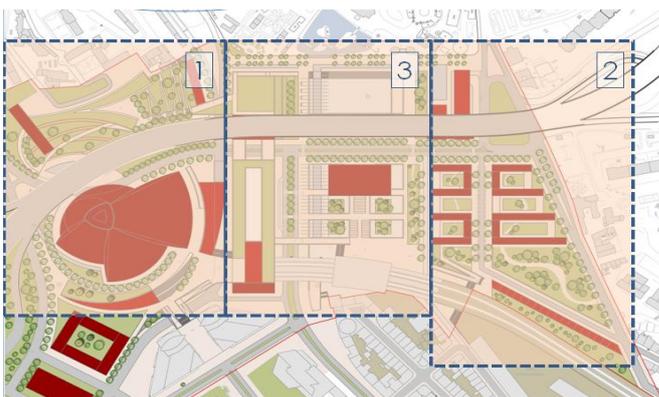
Plano de pormenor, dividido pelas 3 zonas.
